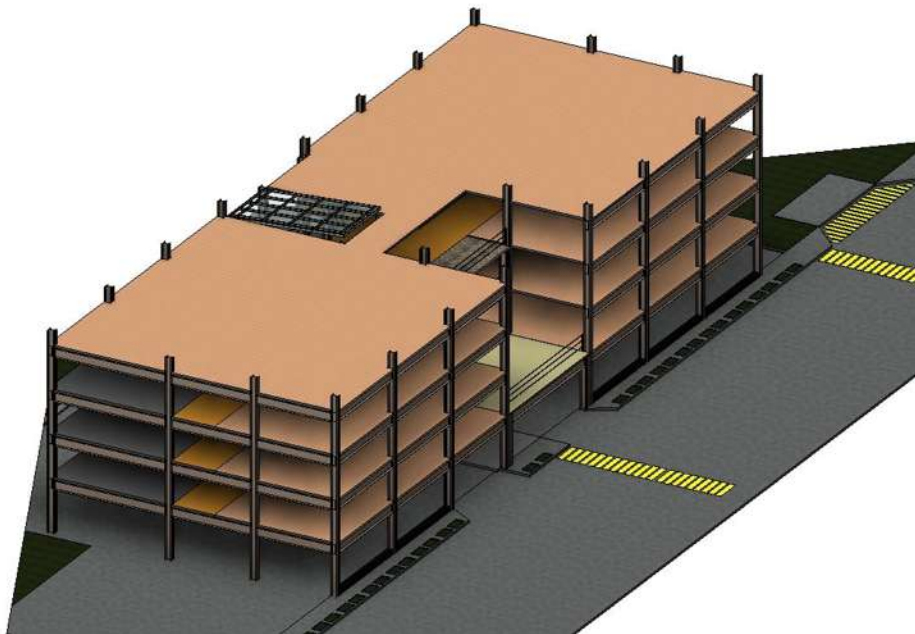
Estructura metálica dentro del proyecto. Fuente: autor
